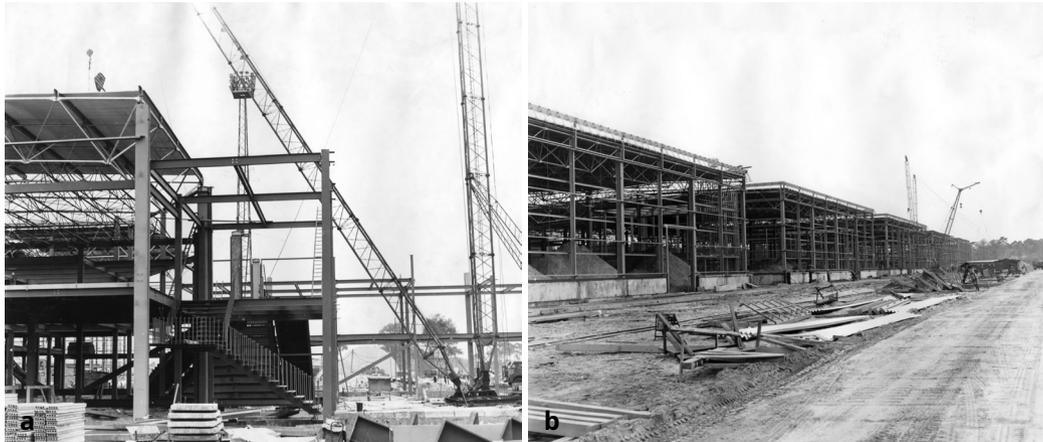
Richard Paulick, AMLO, Berlin-Wuhlheide. a: Errichtung der Ausstellungshallen, Bauaufnahme mit Kran, Fotografie, wahrscheinlich Frühjahr 1969, Architekturmuseum der TU München; b: Errichtung der Ausstellungshallen, Ansicht des Stahlgerüsts, Fotografie, wahrscheinlich Frühjahr 1969, Architekturmuseum der TU München.
